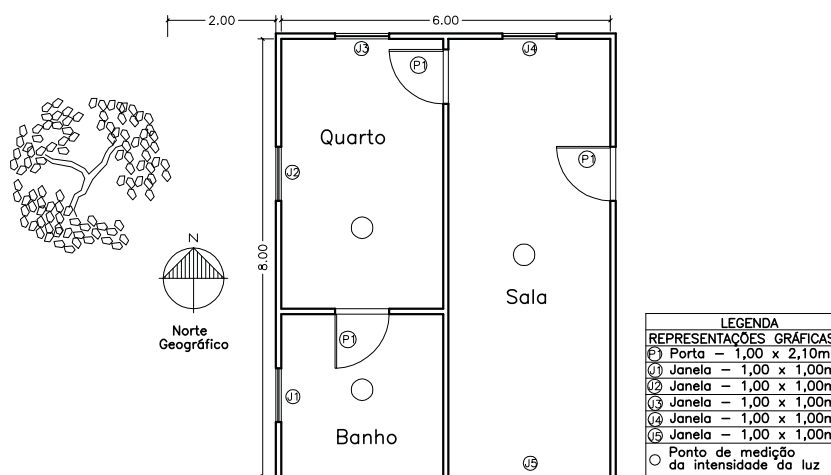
Casa Original com Árvore – Estudo de Caso 2 – Planta Baixa
